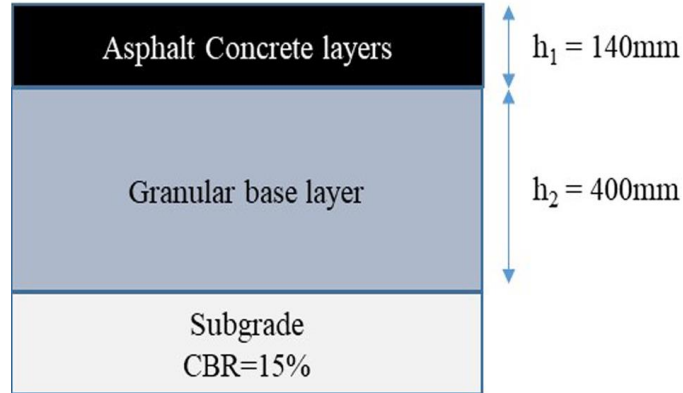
Coupe transversale de la chaussée de la piste d'atterrissage. [7]
